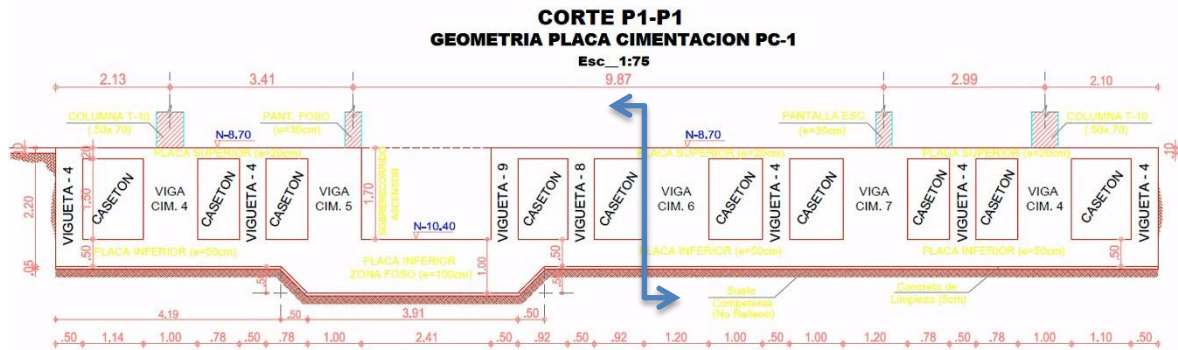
Corte transversal P1-P1, losa de cimentación PC-1.
